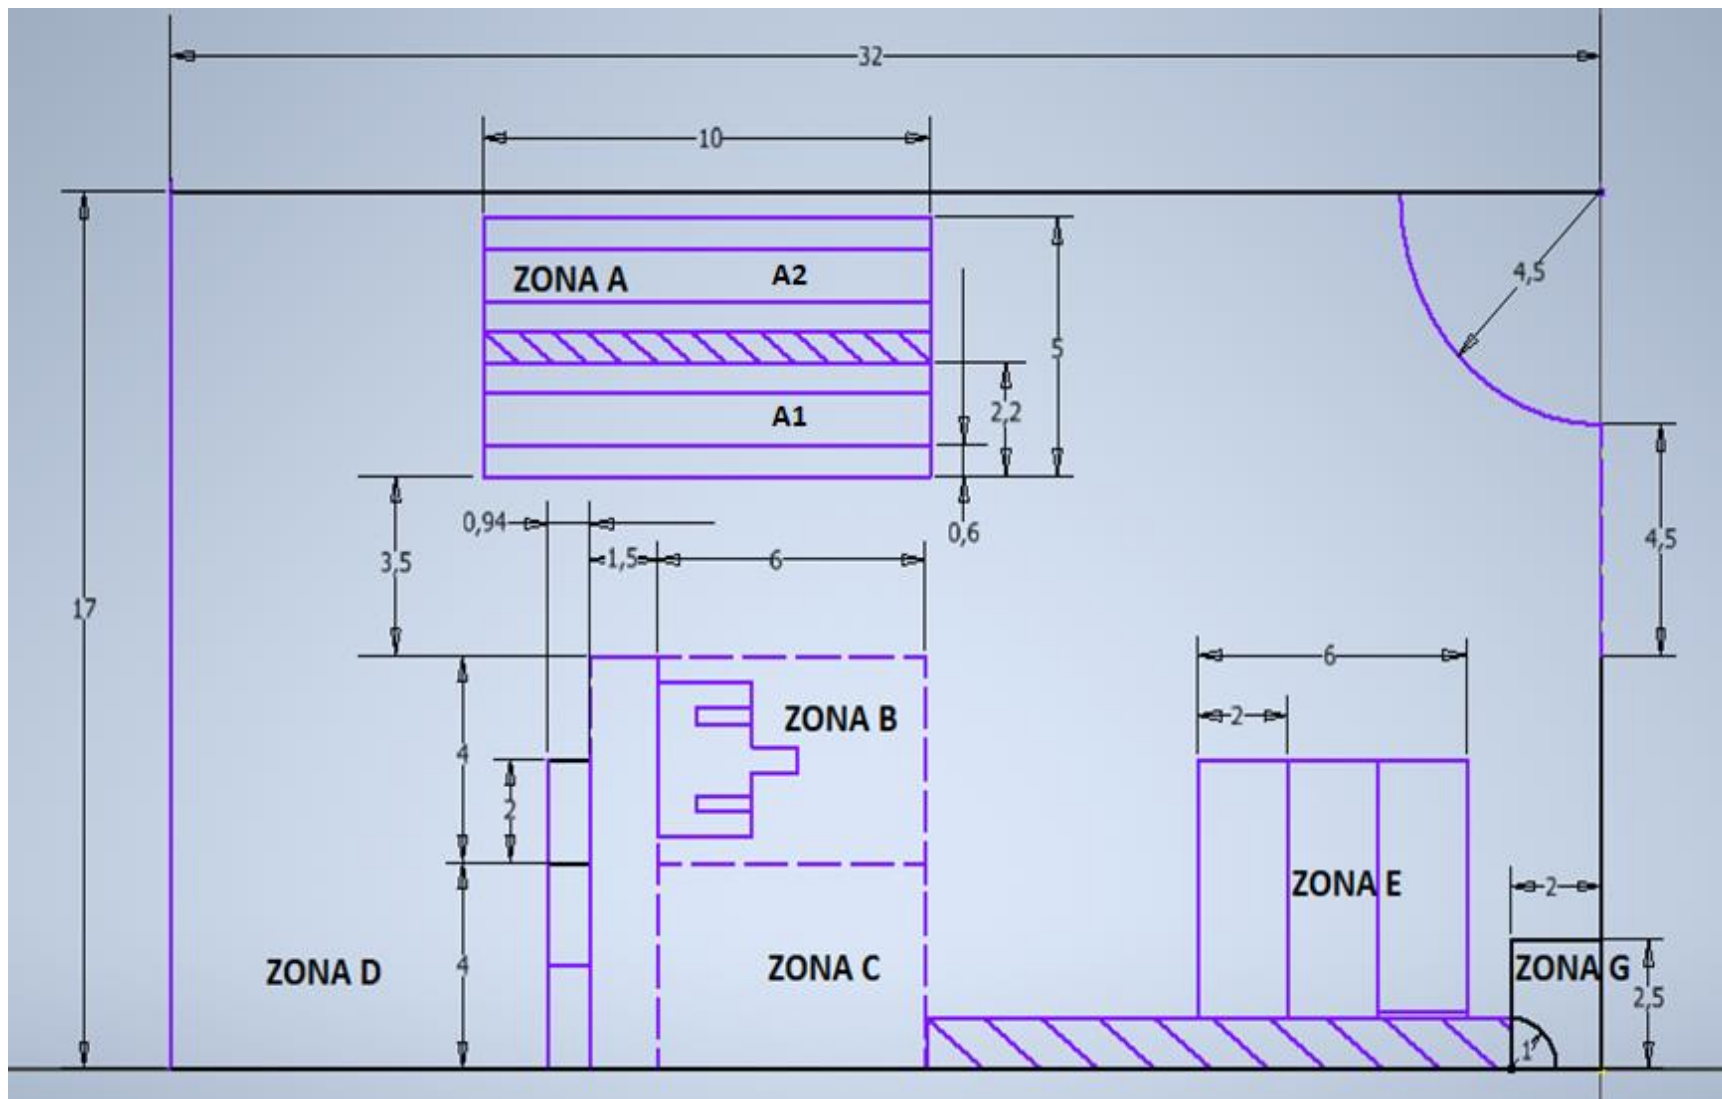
Diseño del Tecnocentro Planta baja. Fuente: Autores.
